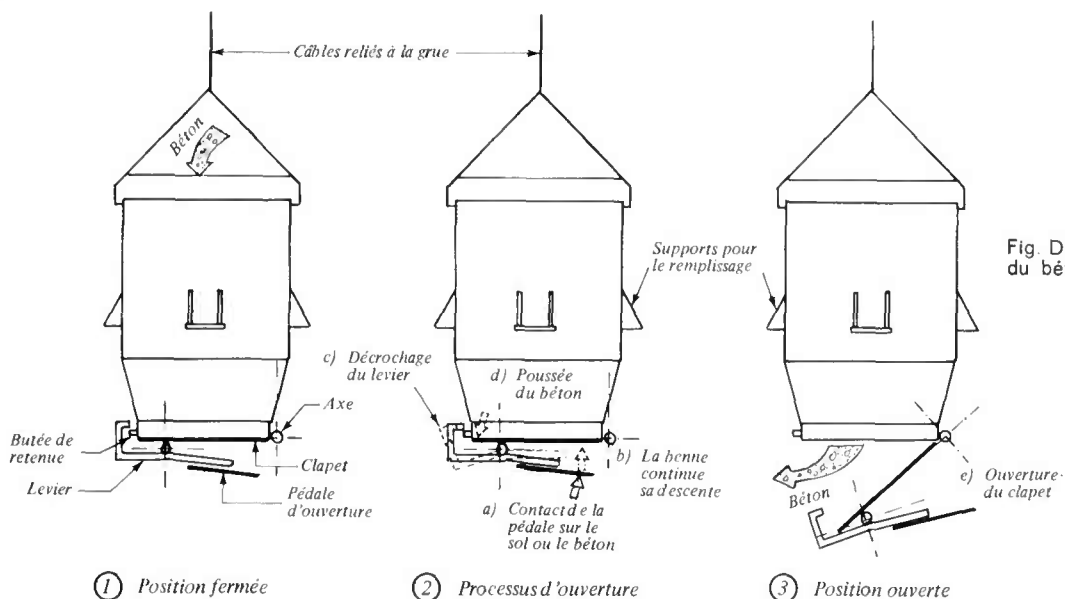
Benne pour la mise en œuvre du béton immergé.
